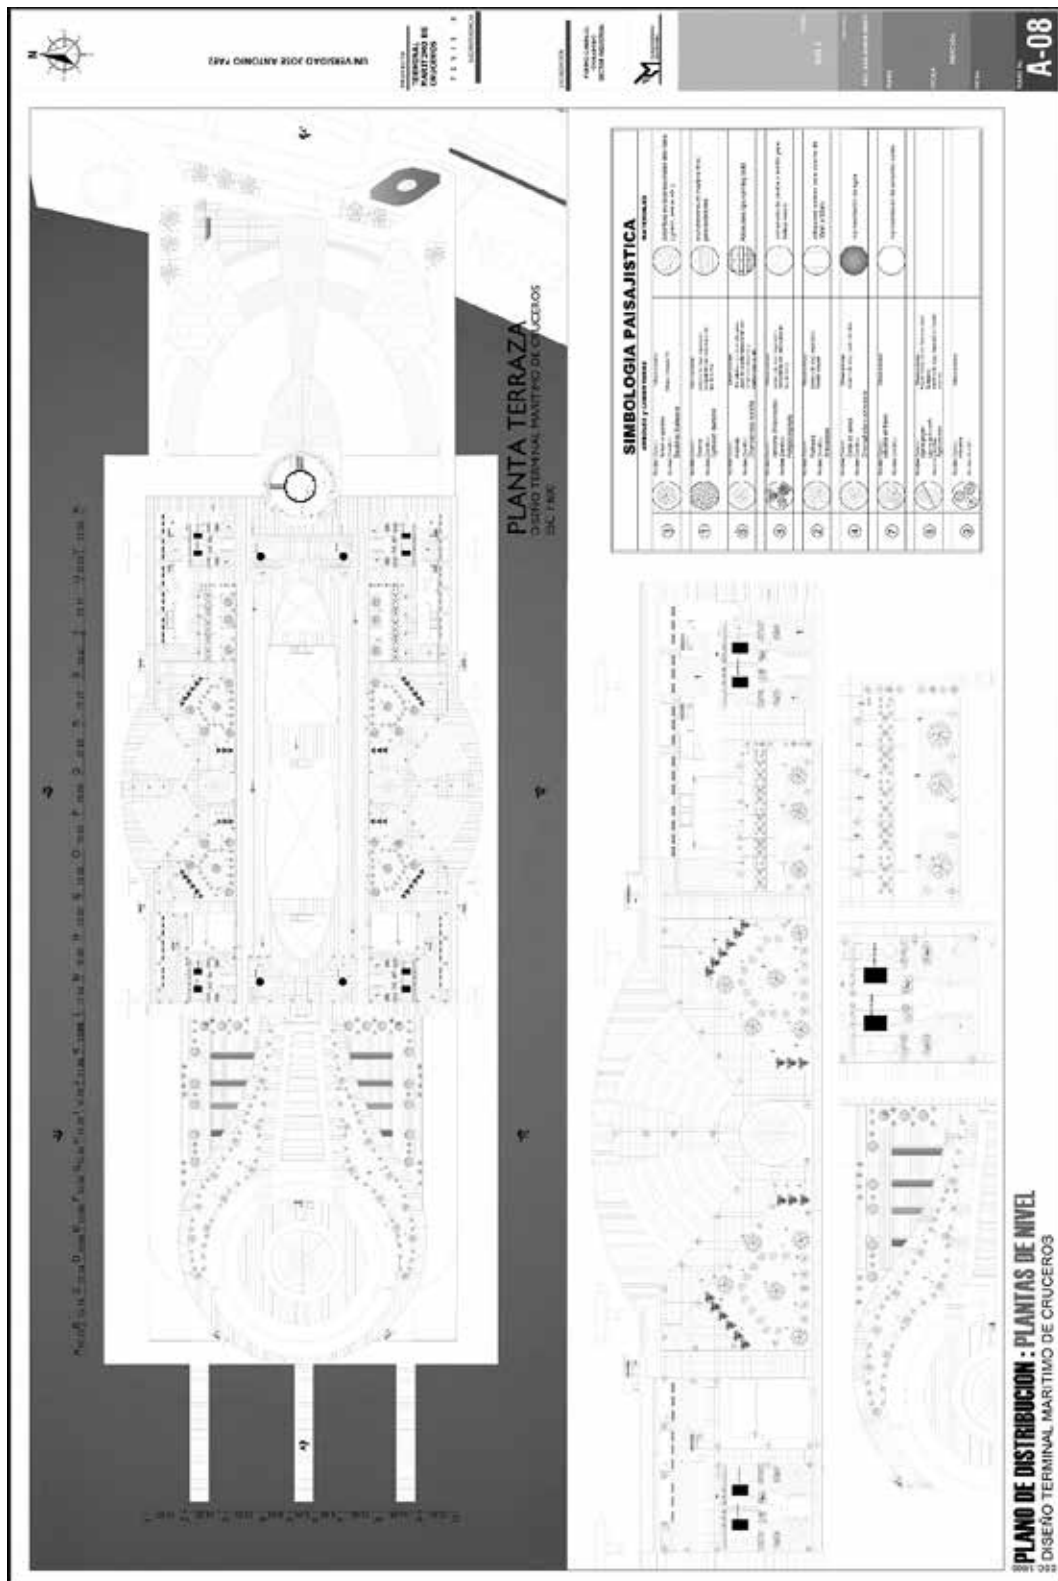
Plano de paisajismo de planta terraza (Nivel +25.75)
